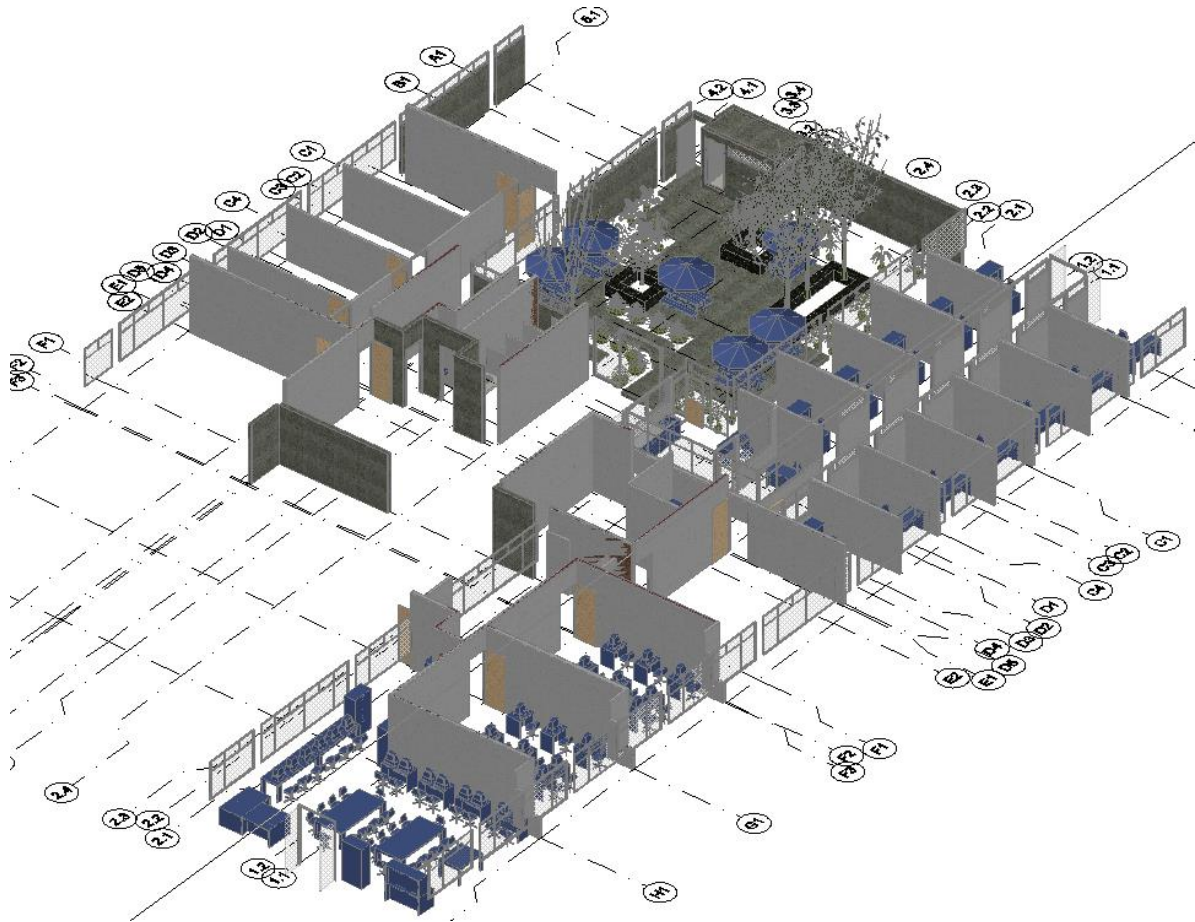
Modelo de Conjunto del Constructor Arquitectónico de la Planta Baja ya remodelada
